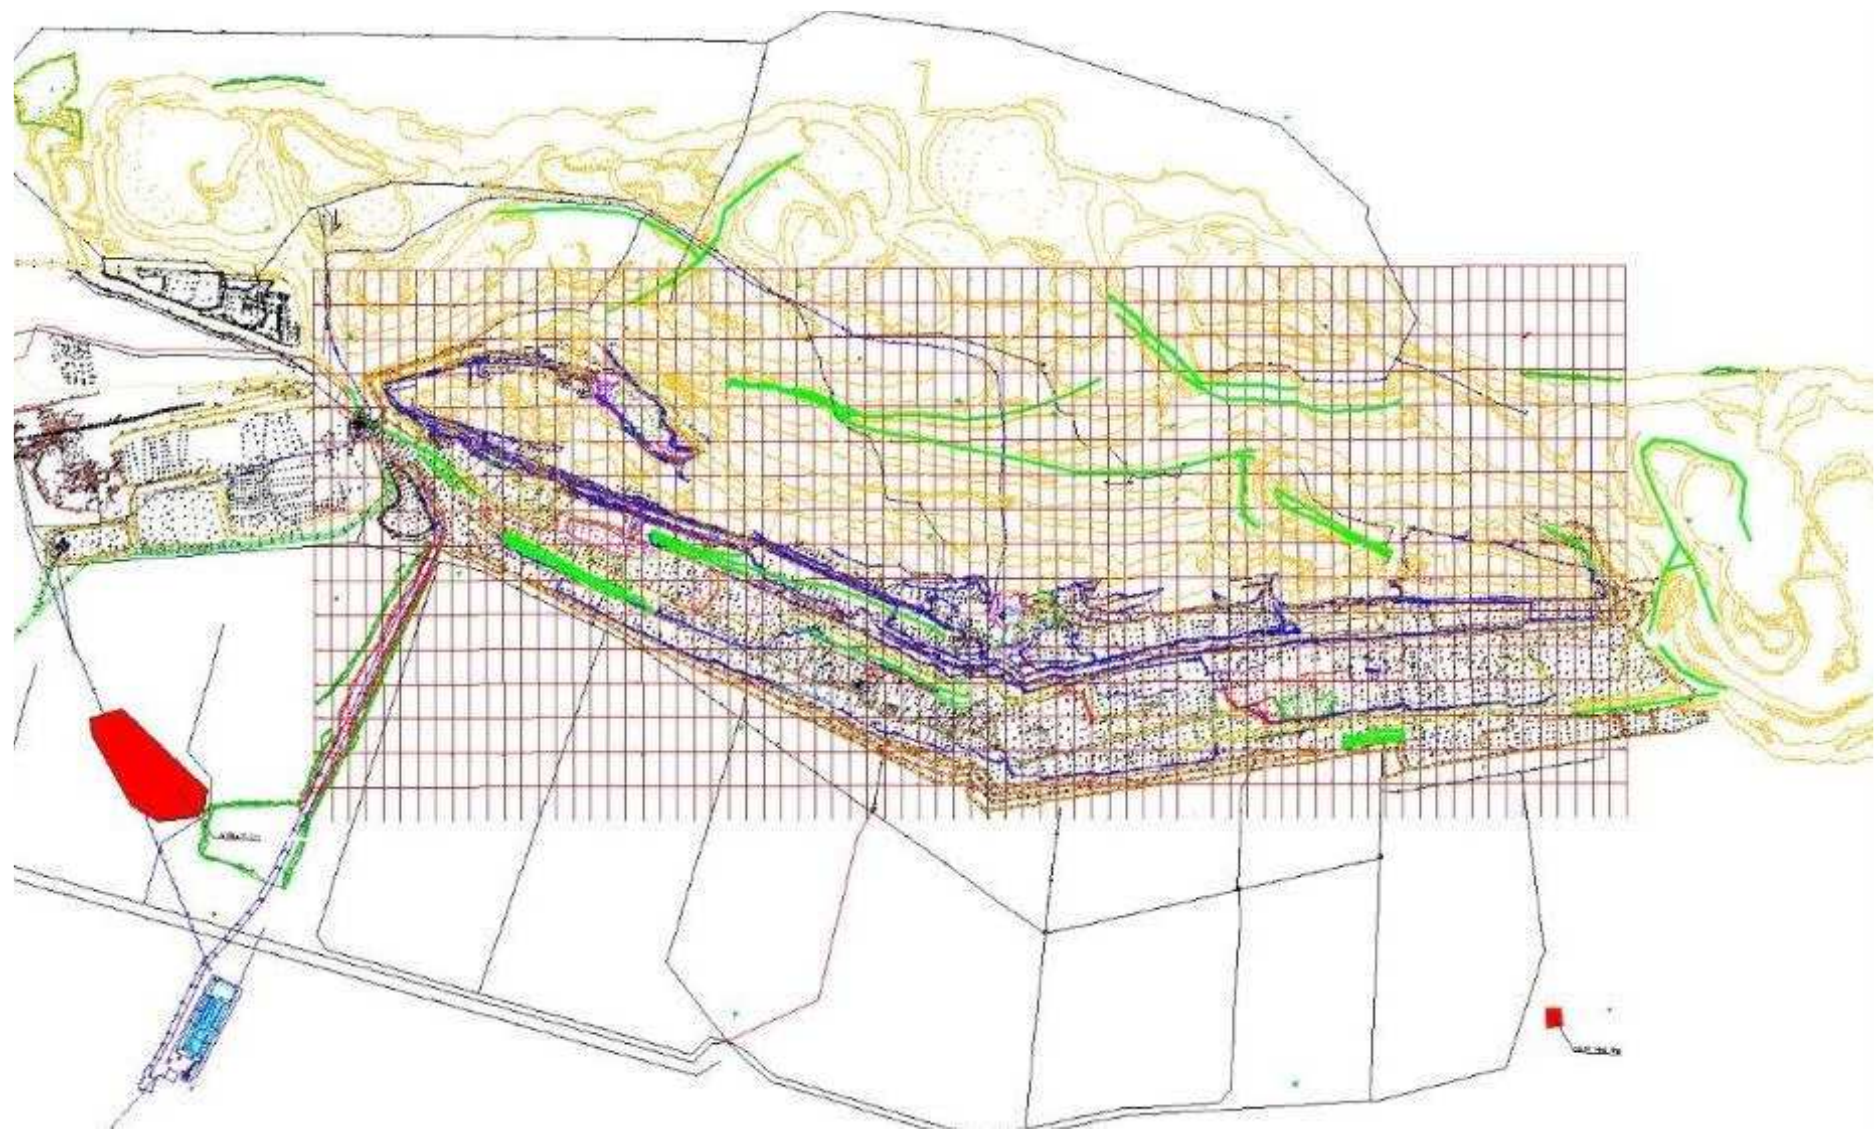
Сводно-совмещенный план разработки Восточно-Бейского угольного разреза
